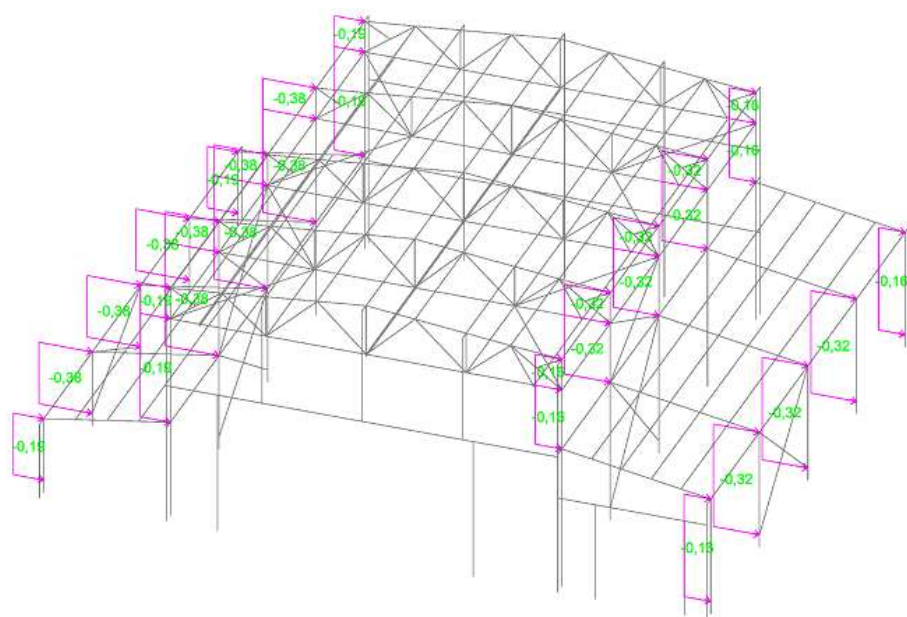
Схема загрузки ветровой нагрузкой слева
